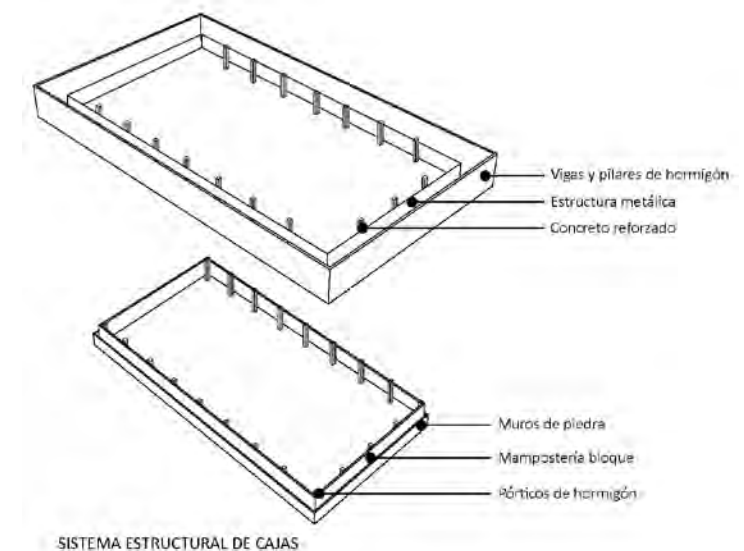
Sistema estructural de cajas – Elaboración Propia
